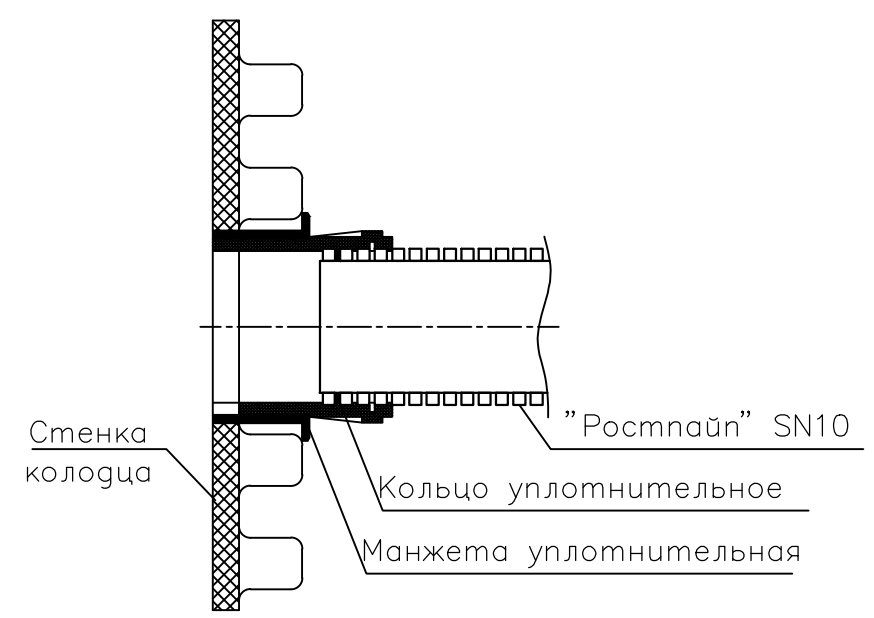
Узлы присоединения трубопроводов из труб "Ростпай" SN10 к колодцам из полиэтилена с помощью врезных полумуфт.
